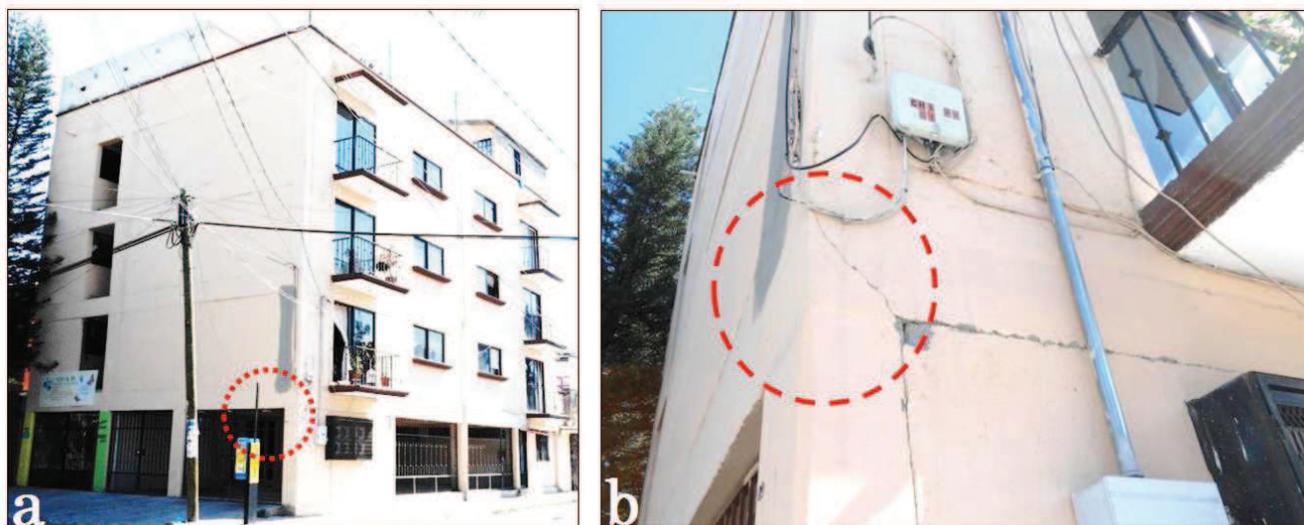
Falla en unión viga columna en edificio reciente con planta baja flexible. Fotografías: Jesús Santos Bautista
